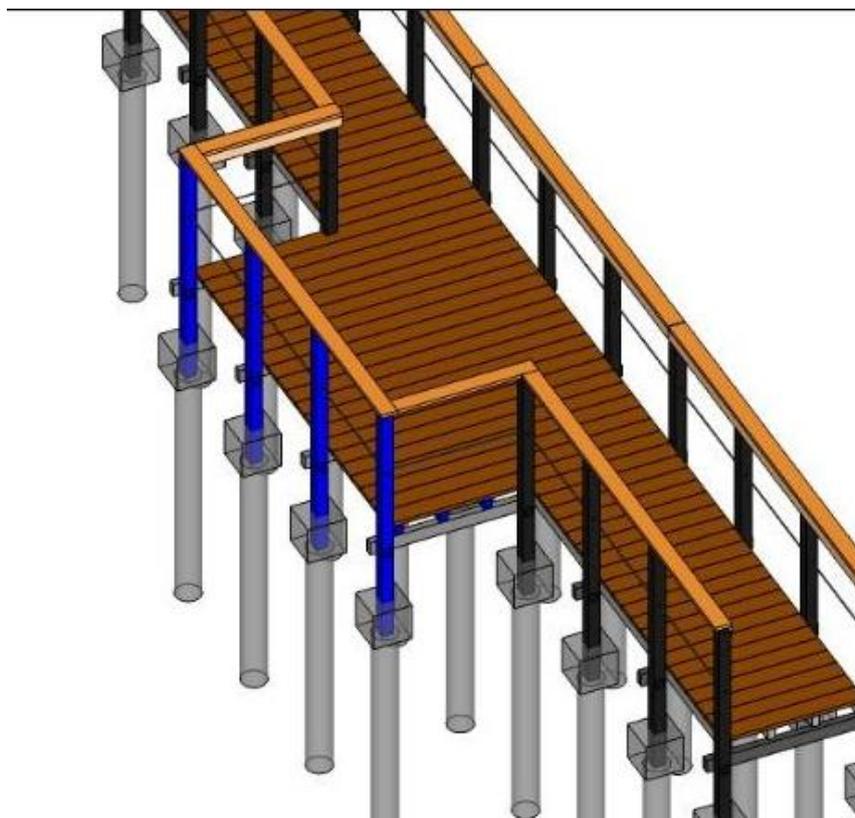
Vista de cima da estrutura da trilha em um ponto de ultrapassagem.
